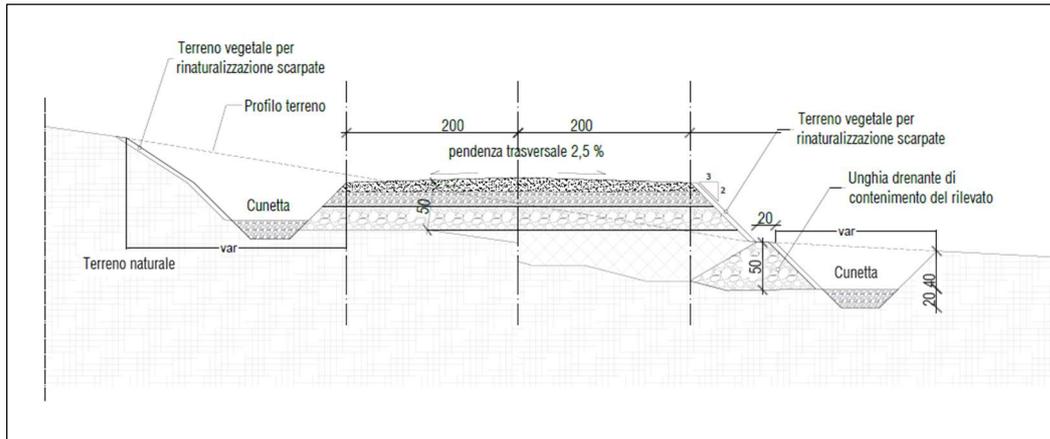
Sezione tipologica del progetto stradale - adeguamento della viabilità esistente
